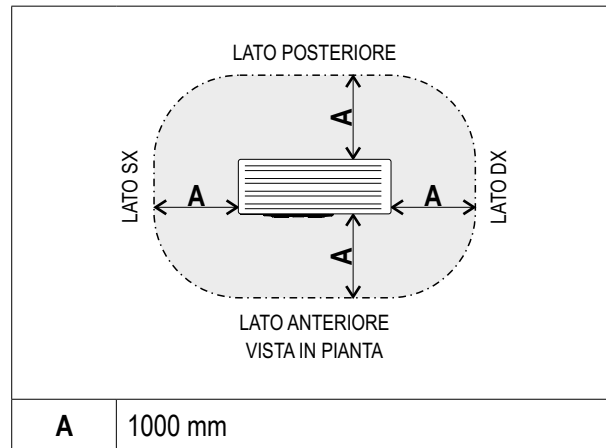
(Zona di sicurezza in caso di installazione a terra - terreno o tetto piano)
